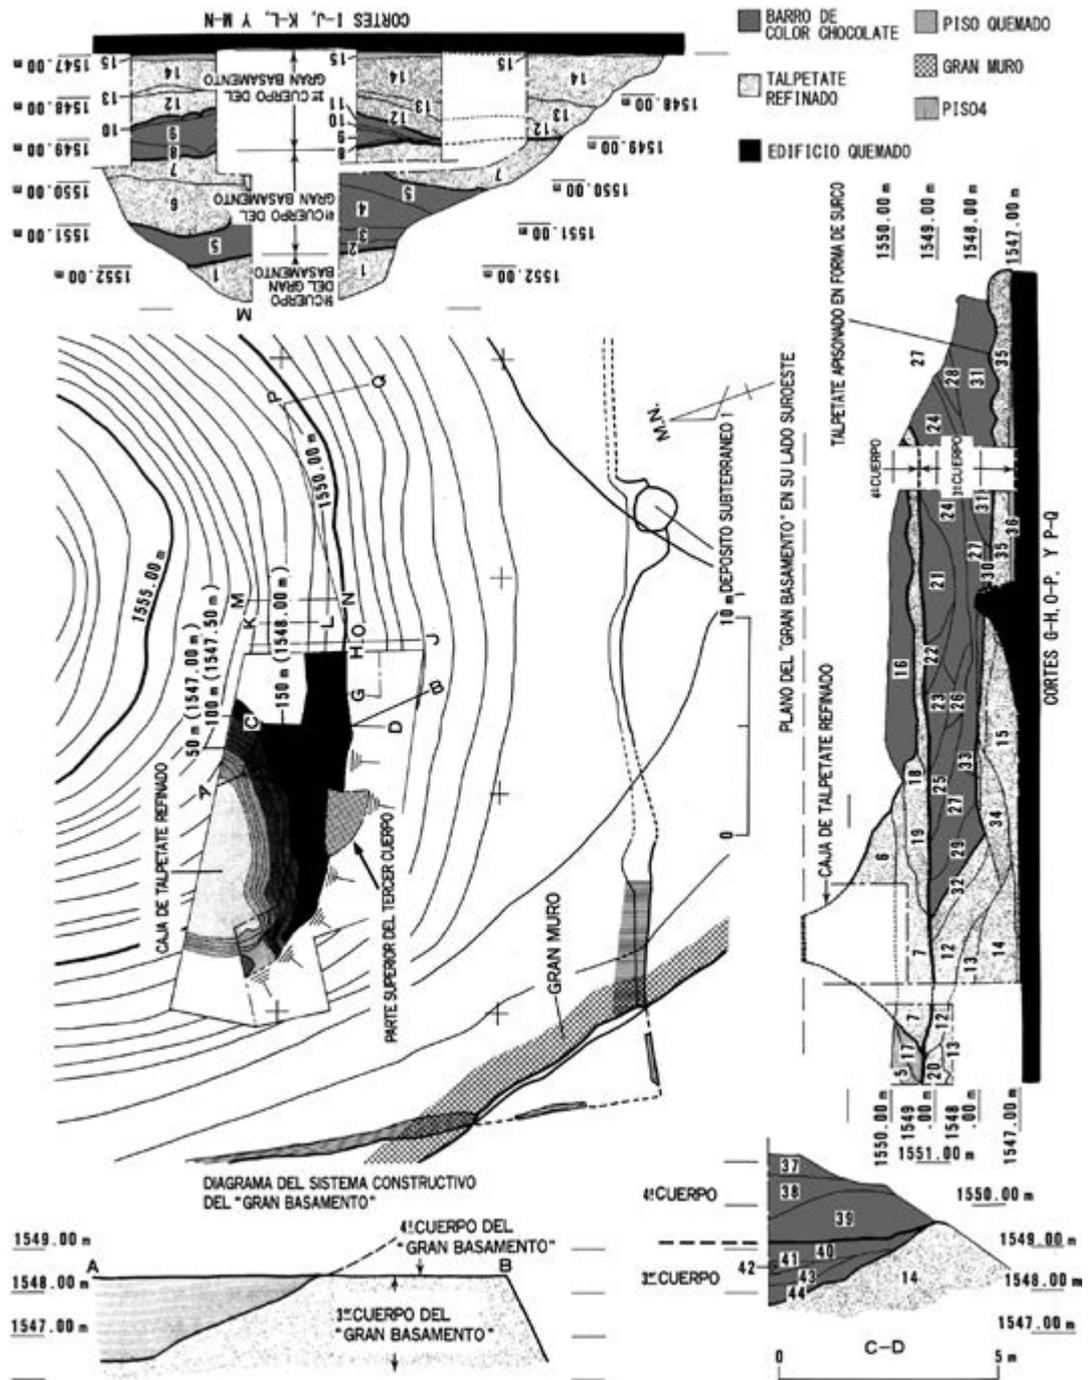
Planta y perfiles del Edificio Mongoy. Sistema constructivo.
